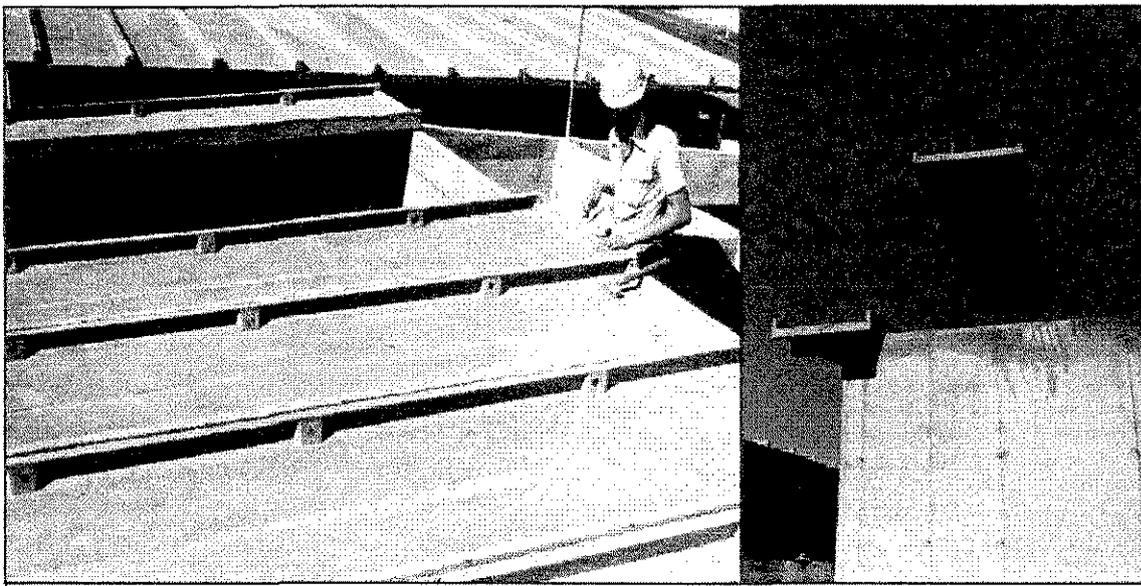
Pré-lajes em argamassa armada – colocação por içamento e fixação – P.N.S.das Dores, em Limeira (SP) - 1982.
